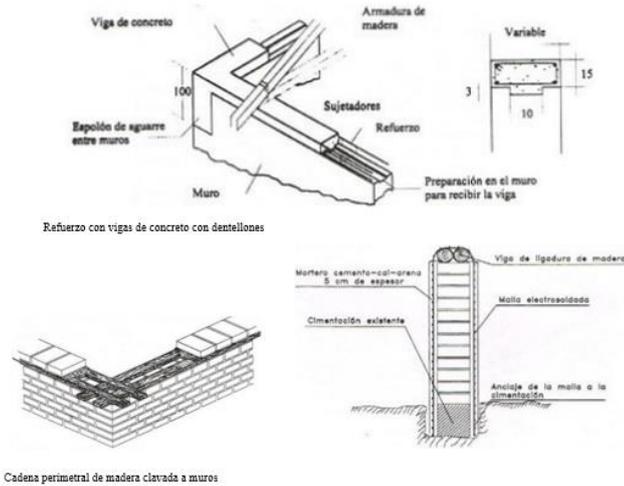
Detalle de refuerzo en muros de adobe perimetral de madera clavada a muros y refuerzo con vigas de concreto armado. Fuente (Rodríguez, 2002) y Forro completo de los muros de la construcción con aplanado de 5 cm de espesor de mortero-cal-arena, con malla electro soldada o malla de gallinero clavada en ambas caras de los muros.
